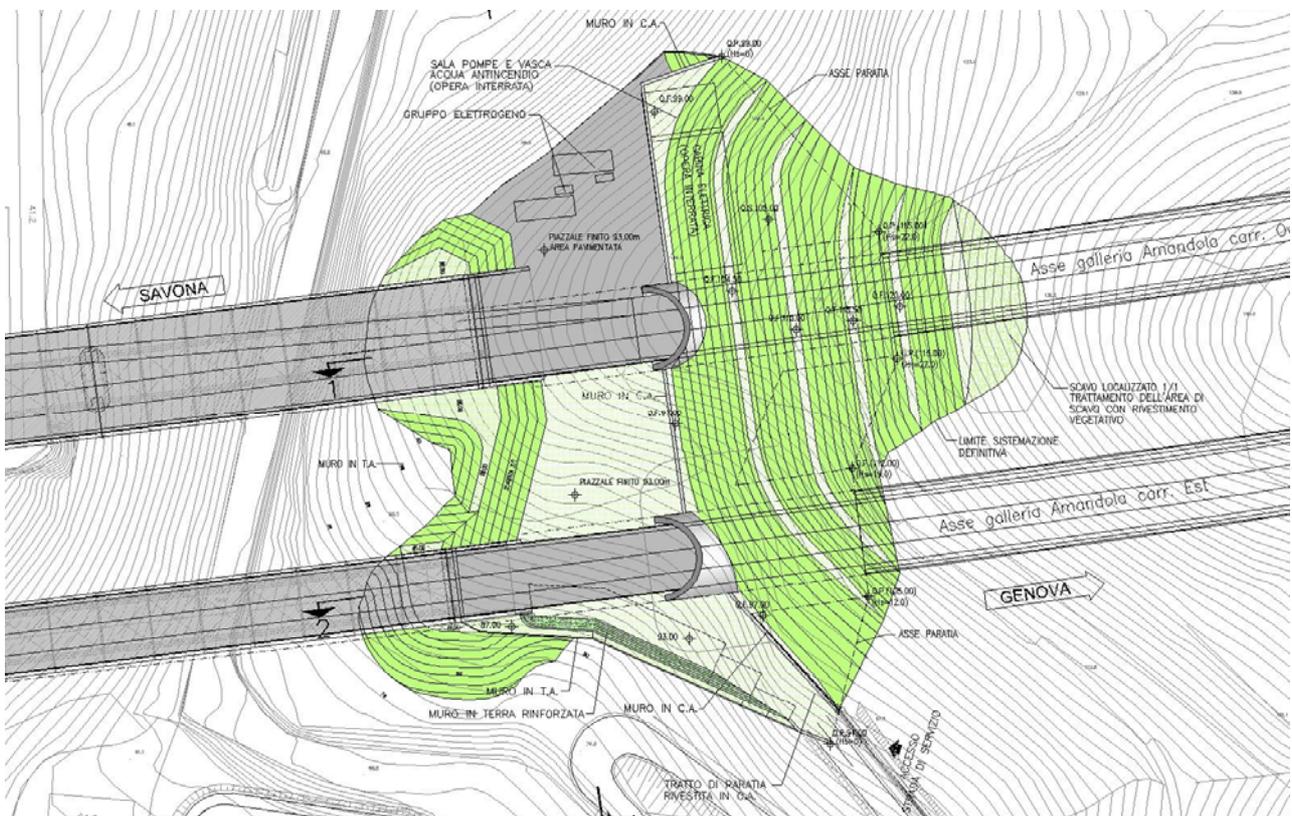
Planimetria d'imbocco galleria Amandola lato Savona (cfr. AUA0136-2)
